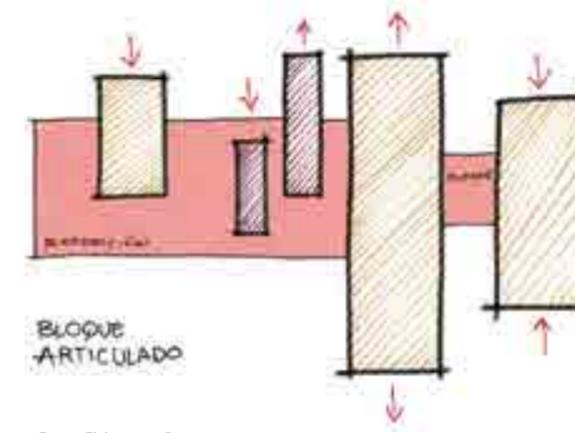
Esquema de Emplazamiento .Fuente:Elaboración Propia
